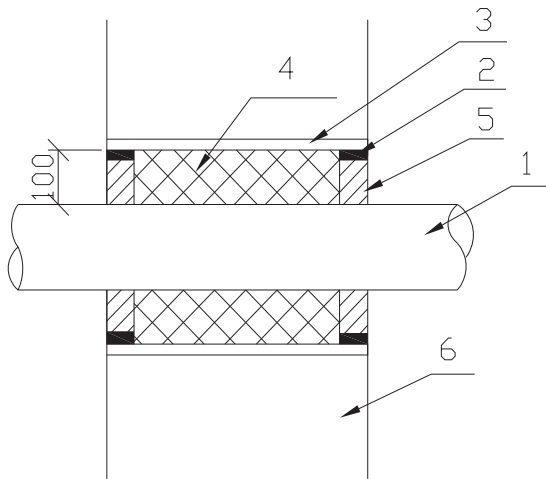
Виброизоляция магистральных трубопроводов в месте прохода через ограждения.
